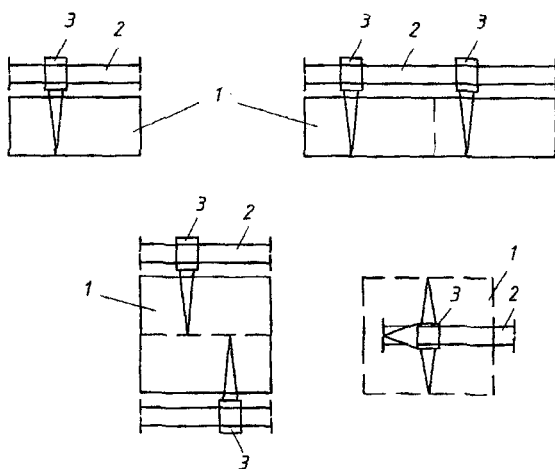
Варианты расположения башенных кранов при монтаже многоэтажных зданий:
